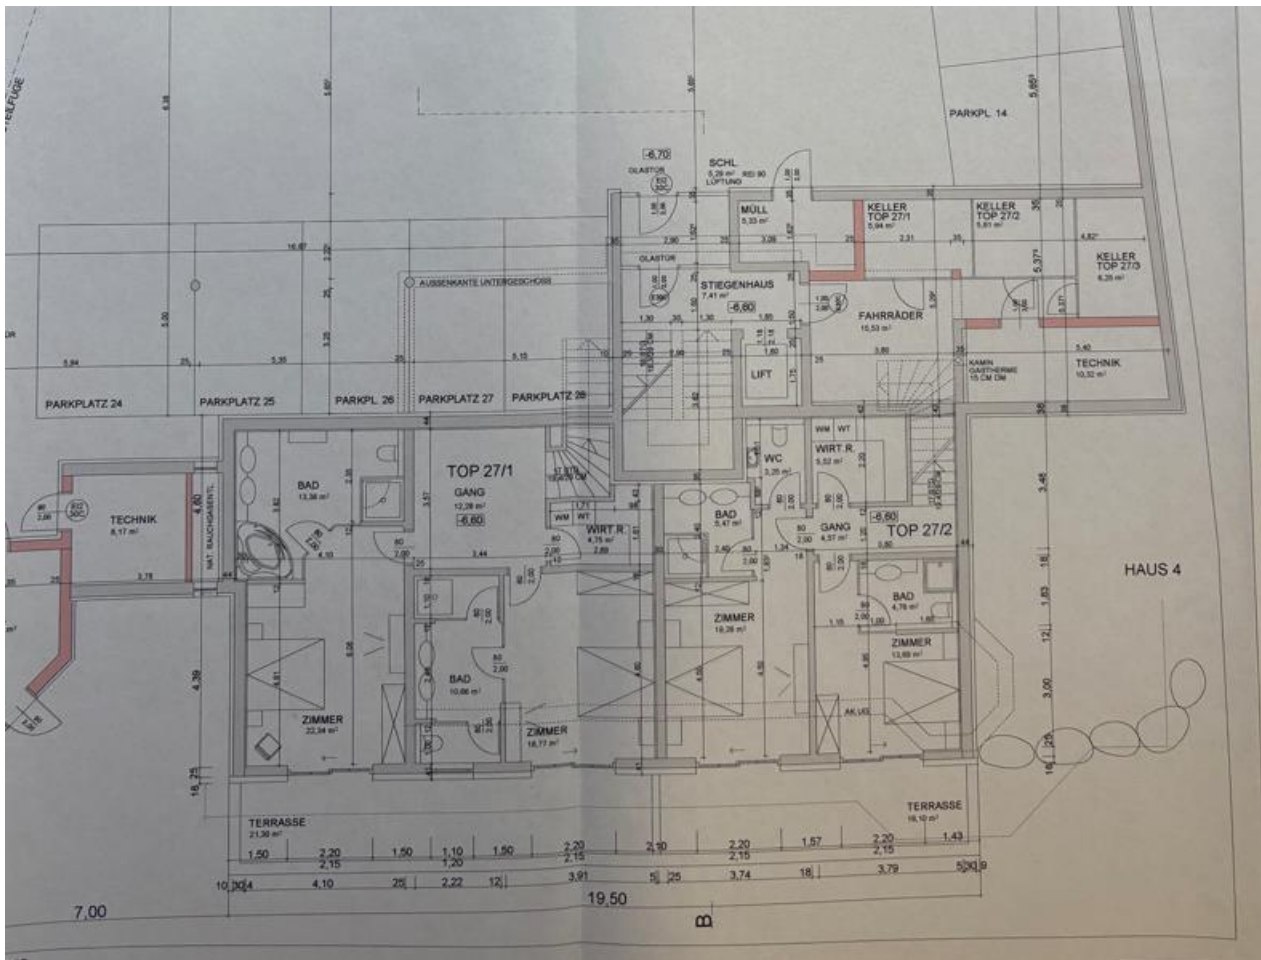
Grundriss Tiefgeschoss¹⁸
